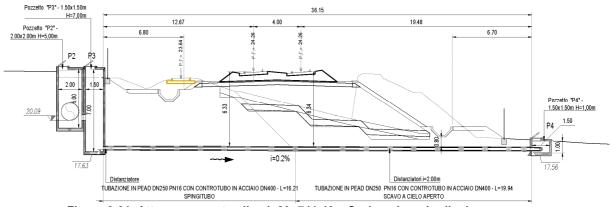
Attraversamento alla pk 29+741,40 – Sezione Longitudinale
